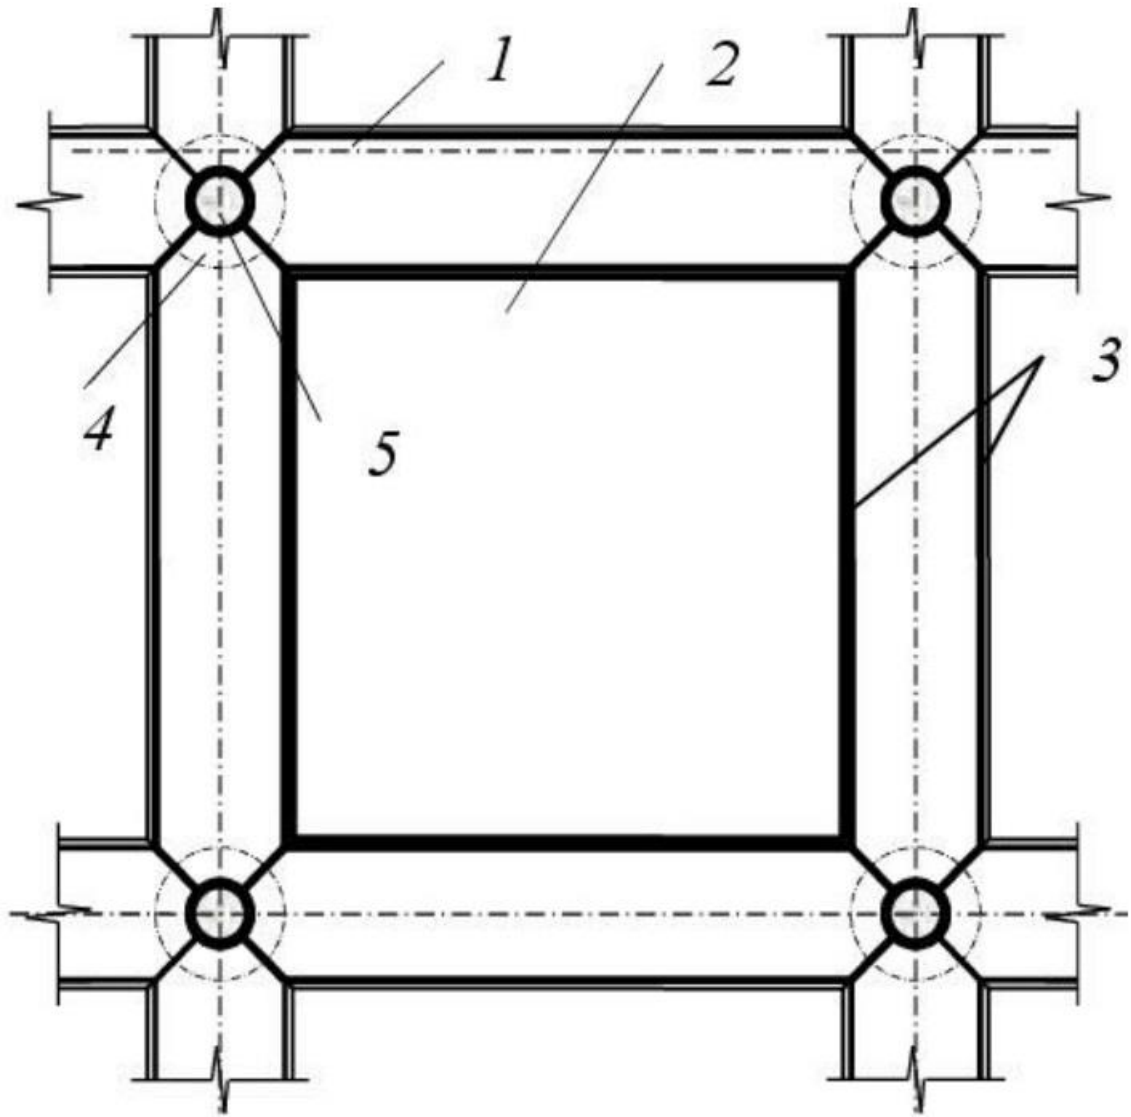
Фрагмент збірного залізобетонного безбалкового перекриття з плитою:
